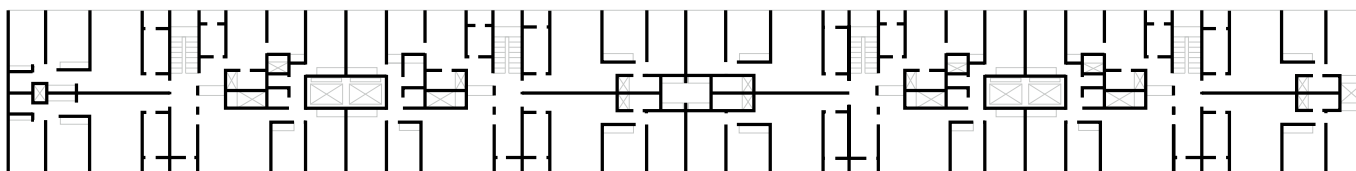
Planta pavimento-tipo do edifício residencial tipologia C.
